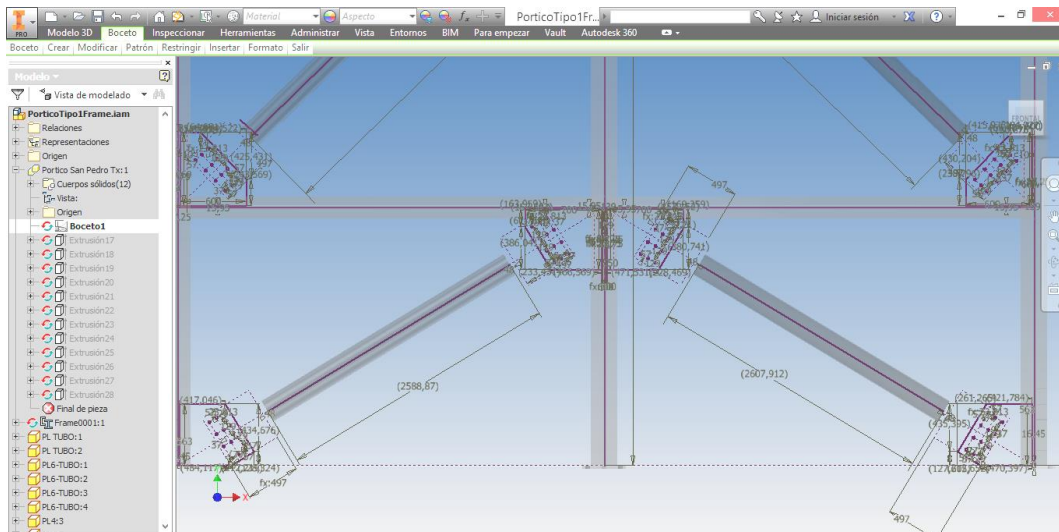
Diseño en Autodesk Inventor de pórticos para Refuerzo estructural Col. San Pedro2.
